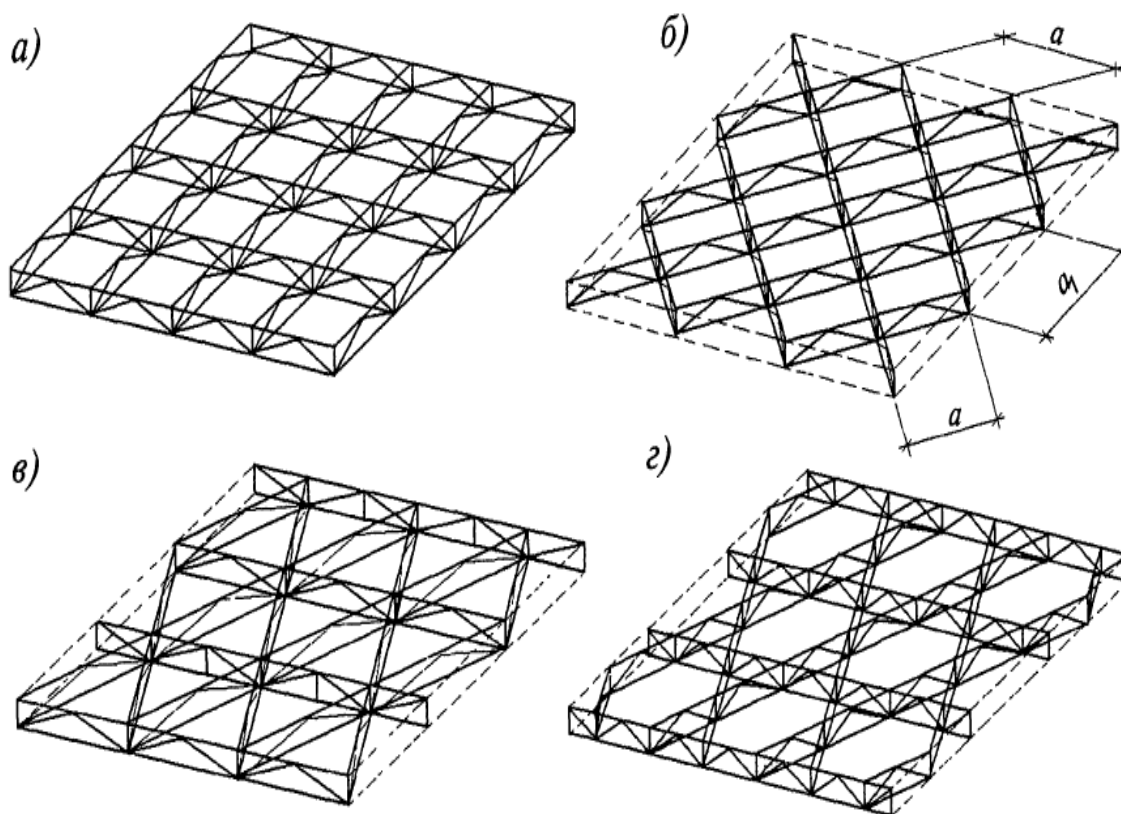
Схемы покрытий из перекрестных ферм:
